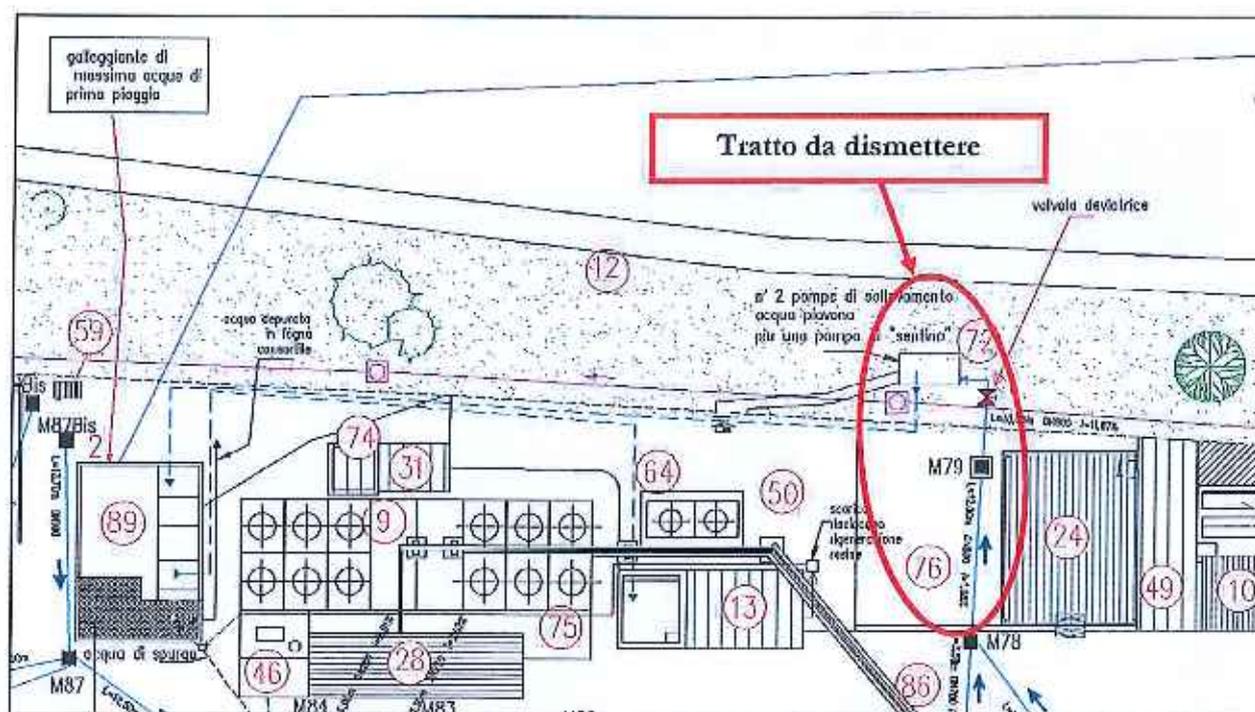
particolare della stazione di sollevamento (stato di fatto)
